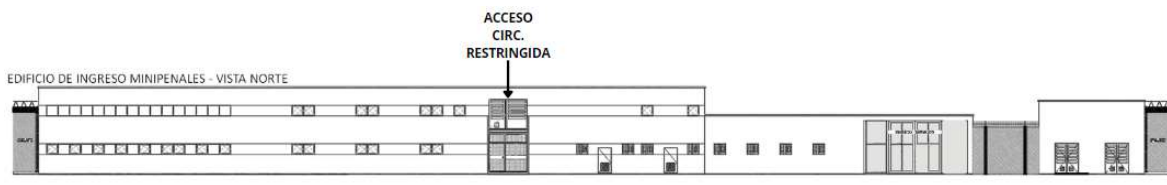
Vista Norte edificio de ingreso minipenal-Acceso a la circulación restringida sobre los techos-Elaboración propia.
